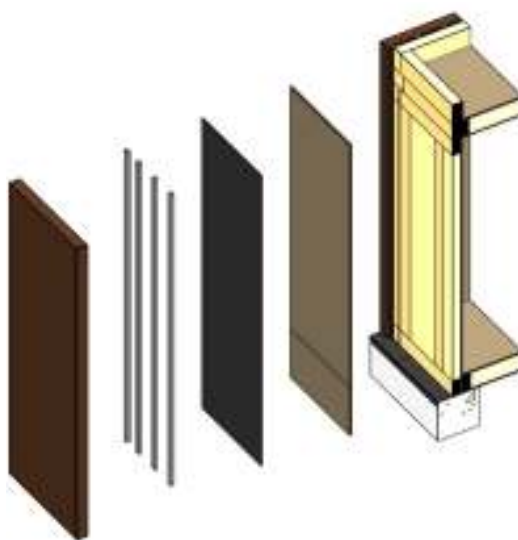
Pormenor construtivo da parede com isolamento na caixa-de-ar.
